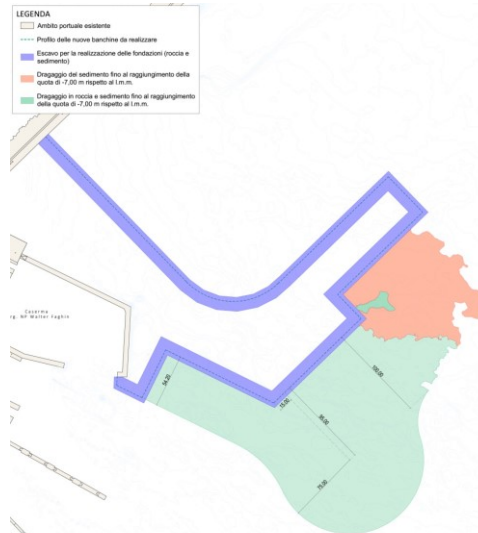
Planimetria del dragaggio (in blu è indicato funzionale alla realizzazione delle fondazioni, in rosso il dragaggio del solo sedimento ed in verde il dragaggio in roccia)
